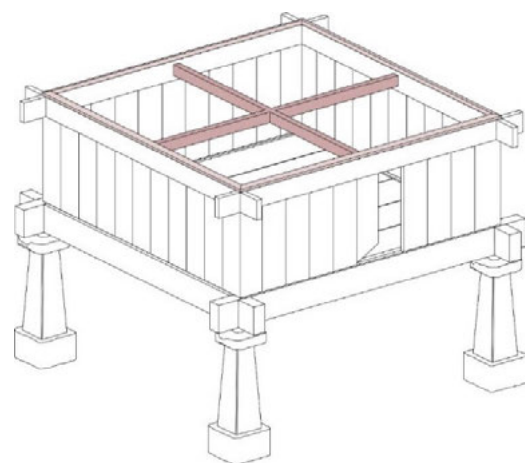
Fase 6 - Colocación de los durmientes y las vigas del queso
